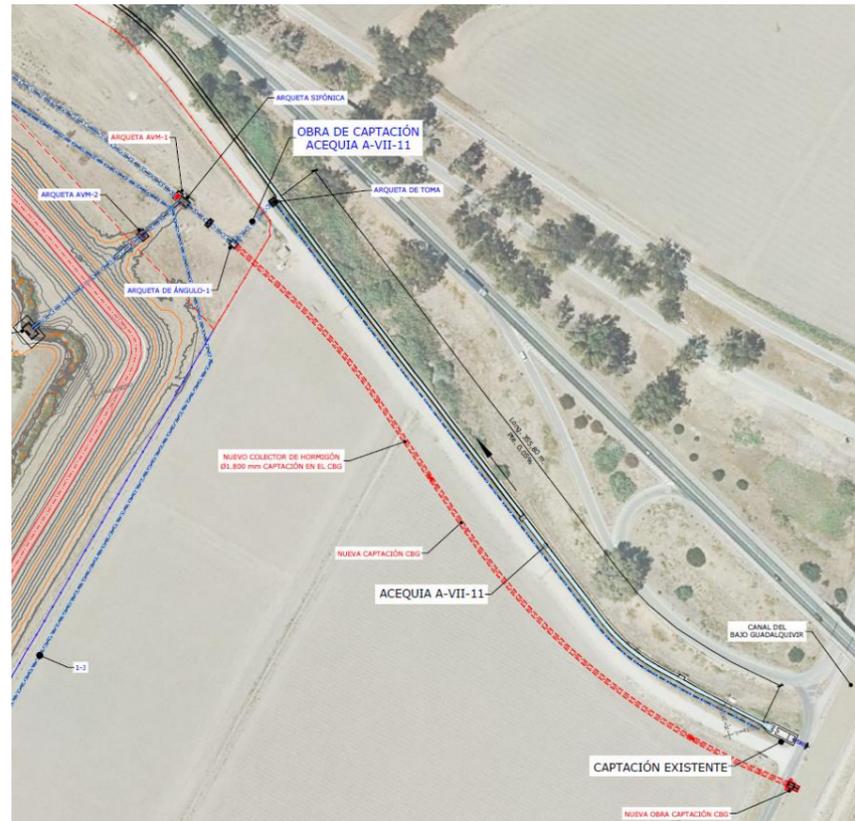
Planta de situación de las obras de captación del sector Alcantarillas. Existente en acequia A-VII-11 y nueva captación paralela
